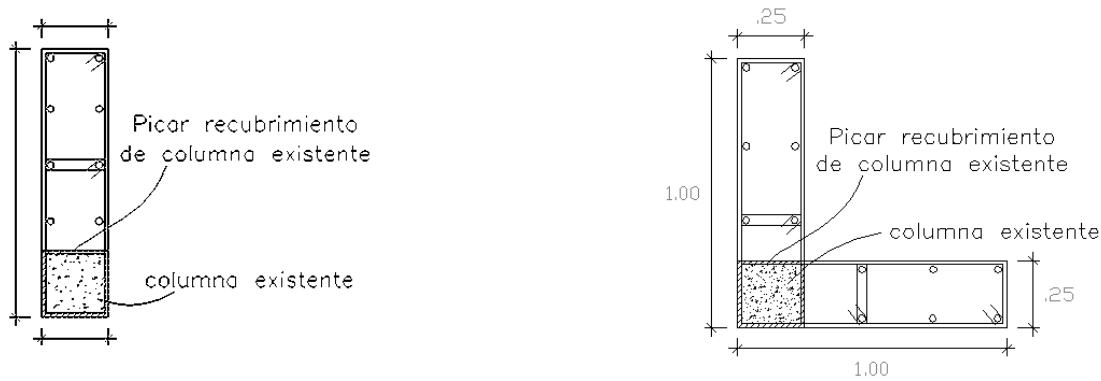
Detalle de reforzamiento para columna existente y esquinera
